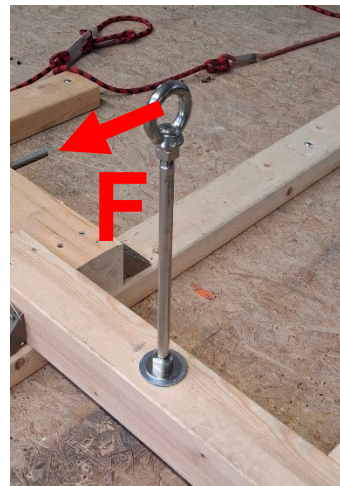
Prüfaufbau D, Anschlageneinrichtung,
